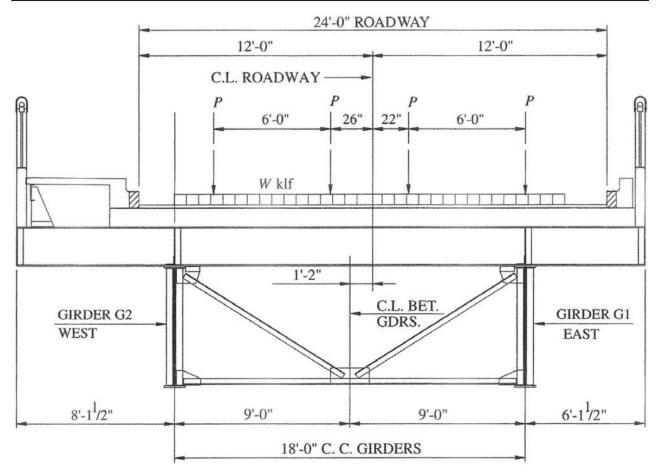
Posiciones de carril críticas para el momento positivo máximo en la viga del piso
